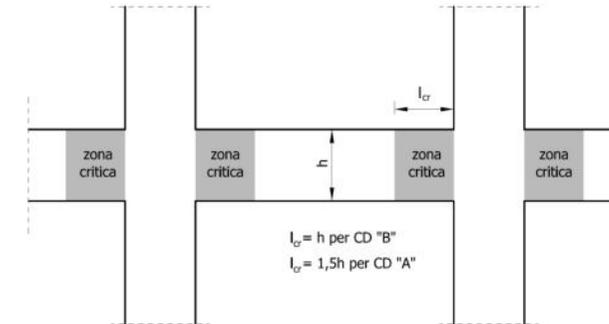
Estensione delle zone critiche alle estremità di una trave (NTC08 § 7.4.6.1.1)
